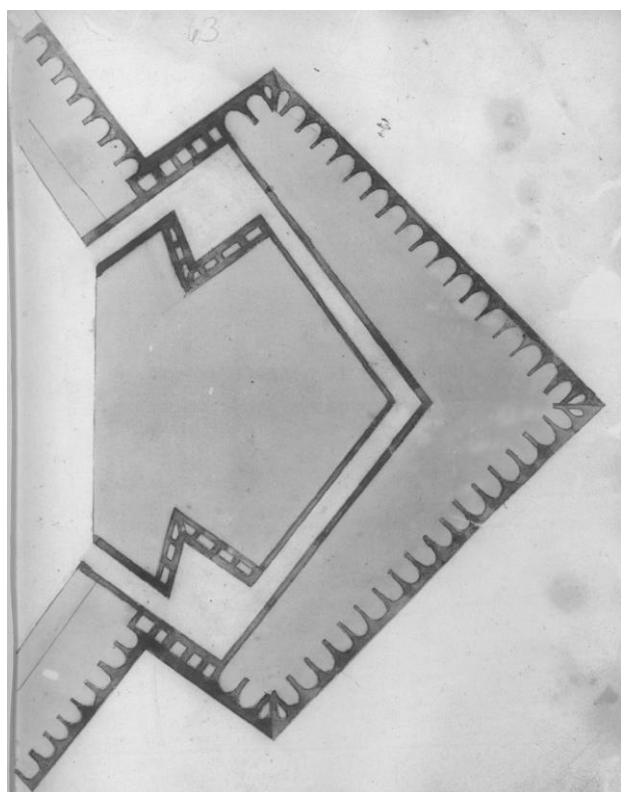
Planta da casamata, planta do terraço do baluarte e Torre de Belém, Lisboa, 1520.
